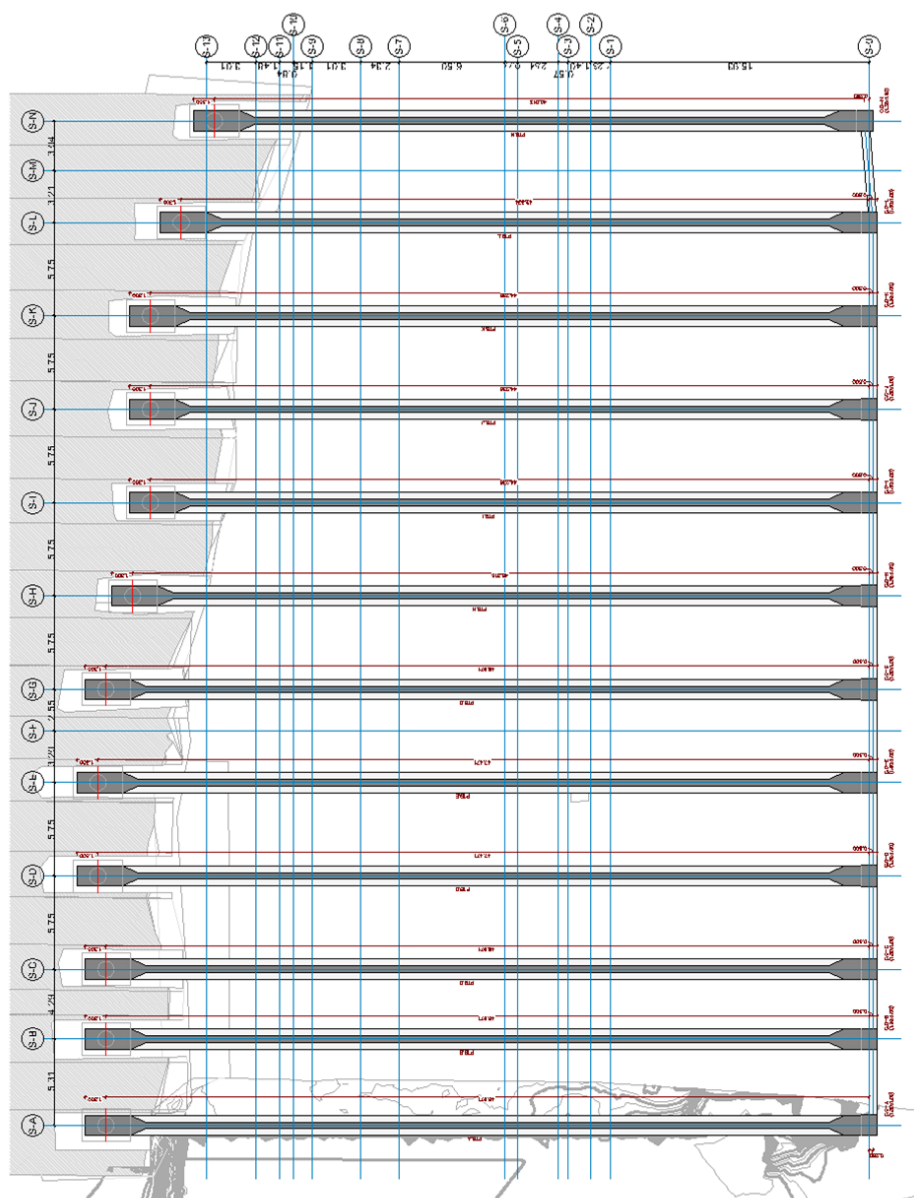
Planta estrutural das vigas pré-esforçadas
